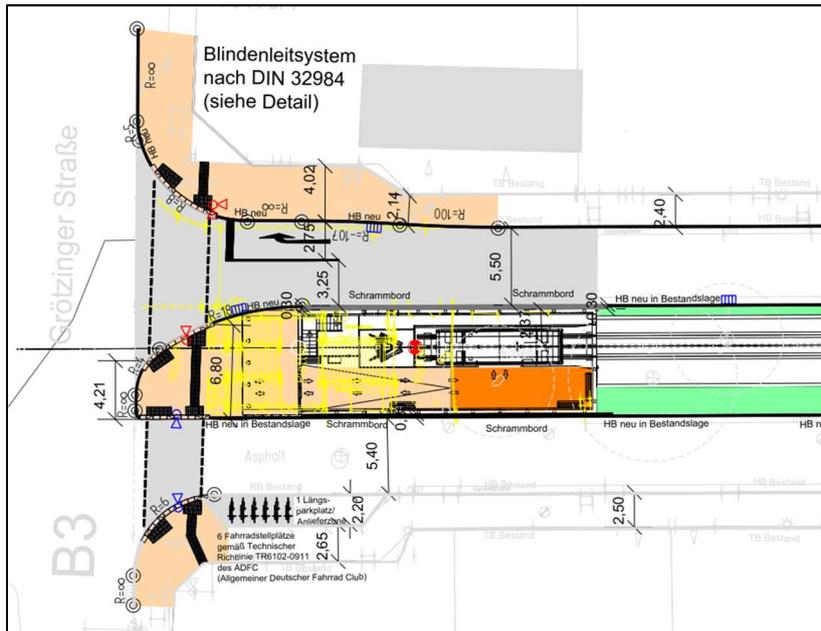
Einmündungsbereich B3 mit Fußgängerfurt (Anlage 4, Plan-Nr. 4206)
